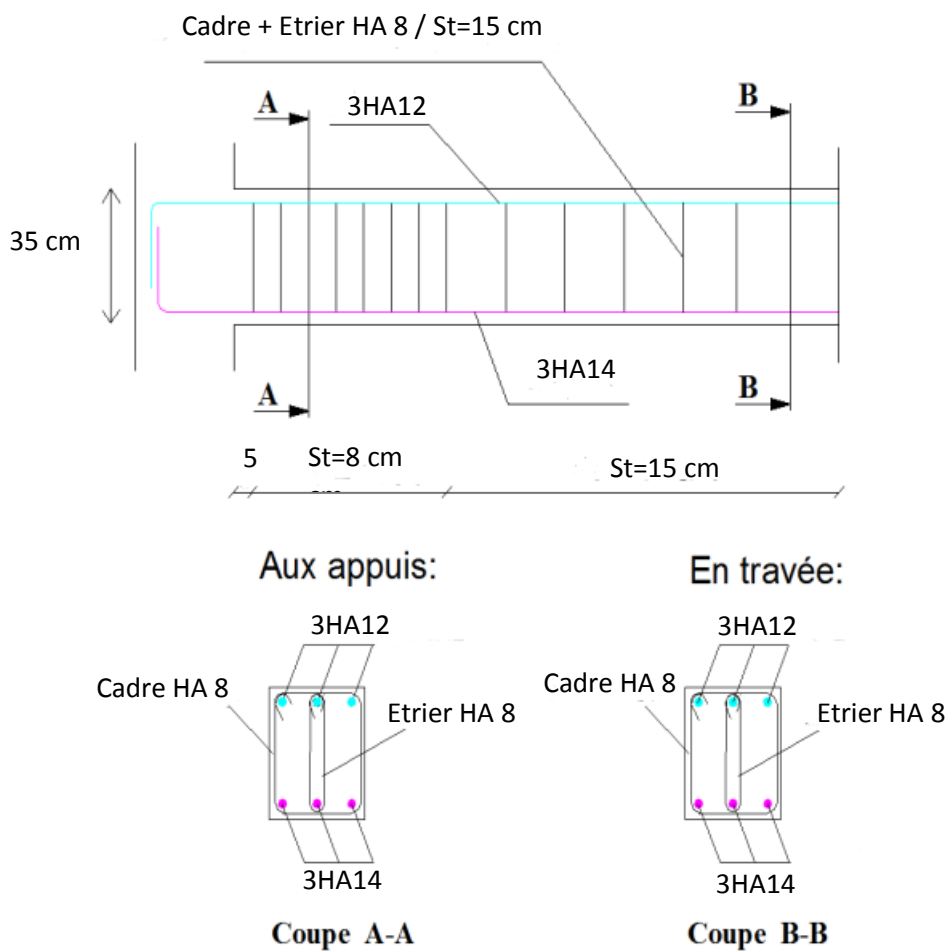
Schéma de ferrailage de la poutre palière .
